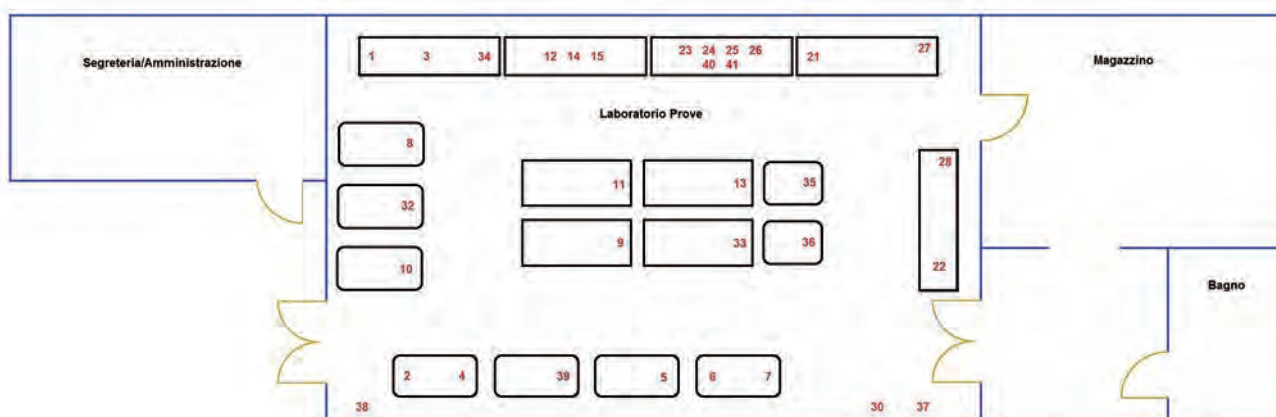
PLANIMETRIA ATTUALE DEL LABORATORIO PROVE
